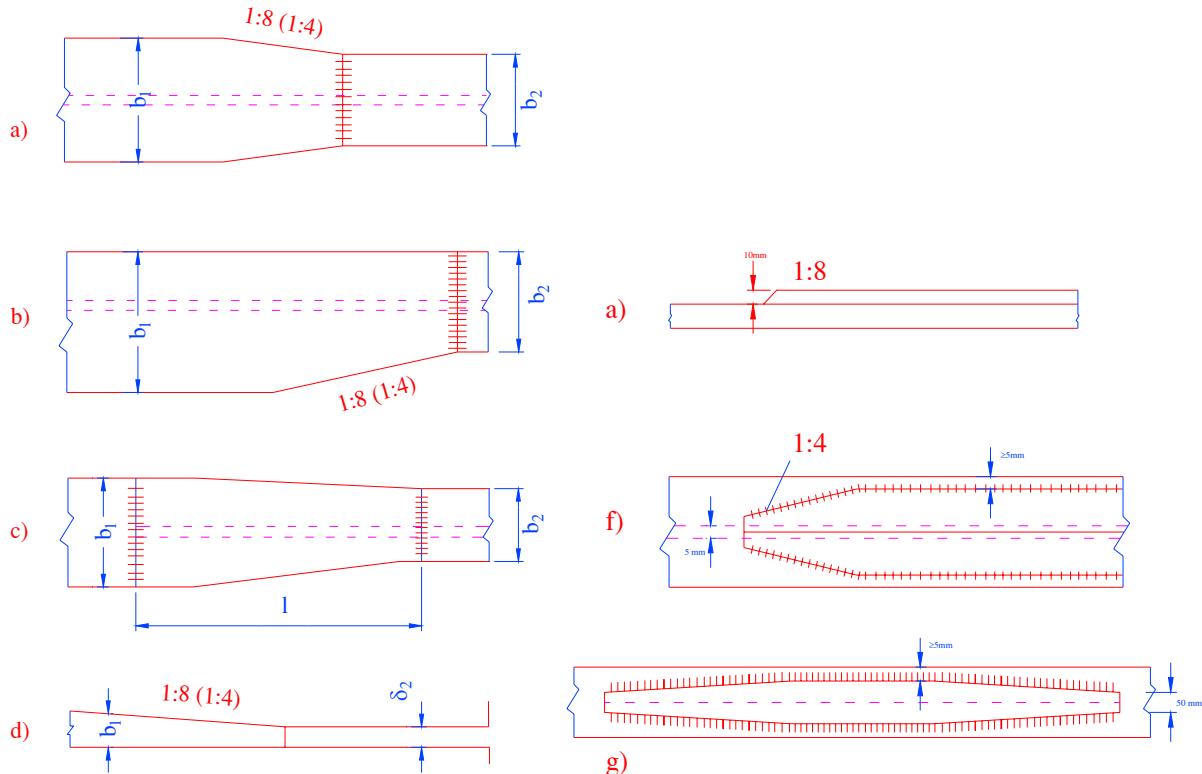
Các yêu cầu cấu tạo bản biên dầm hàn
